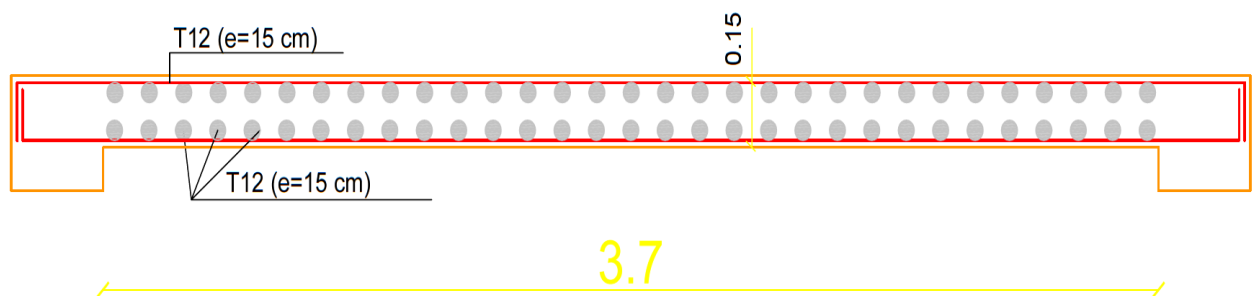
Dessin du ferrailage du voile de contreventement.
